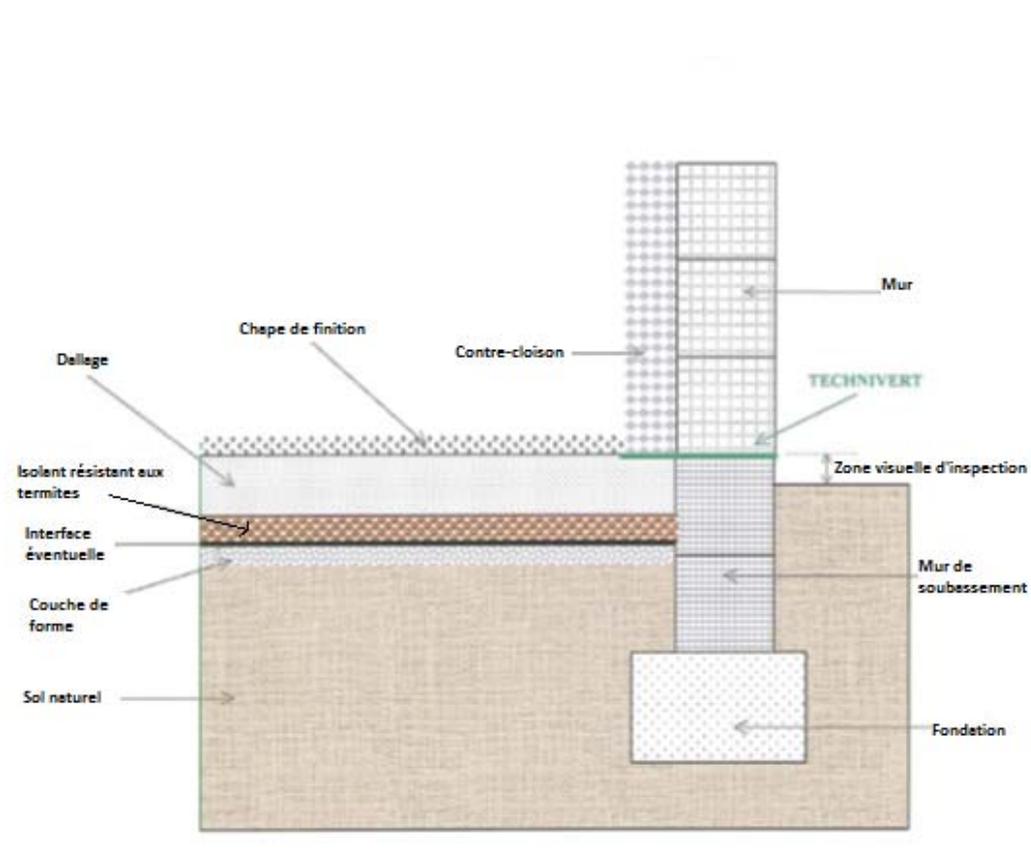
Coupe sur dallage désolidarisé (réalisé suivant le DTU 13.3)
